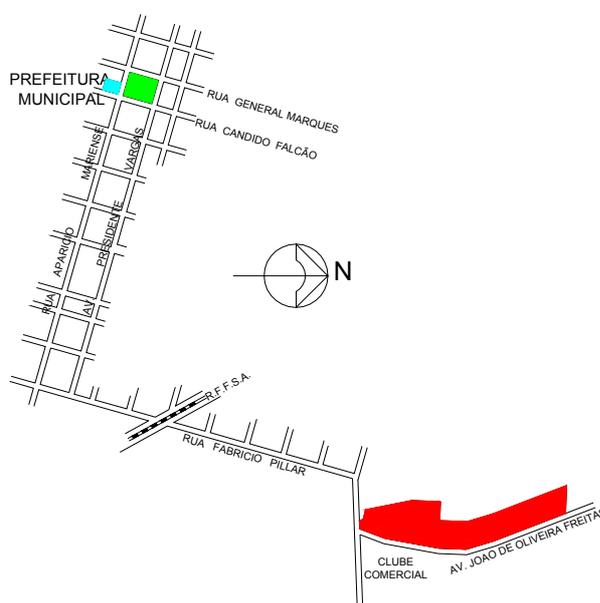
Planta de situação do Conjunto Habitacional São Borja - CHSB
